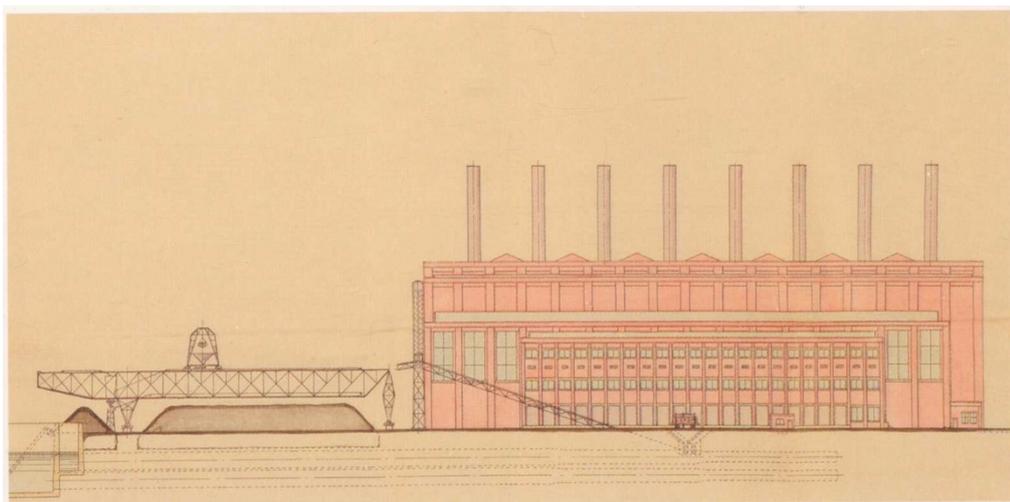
, Battersea Power Station, proposta sopraelevazione ovest Stazione, dal primo progetto dell'ingegnere Pearce, 1927
